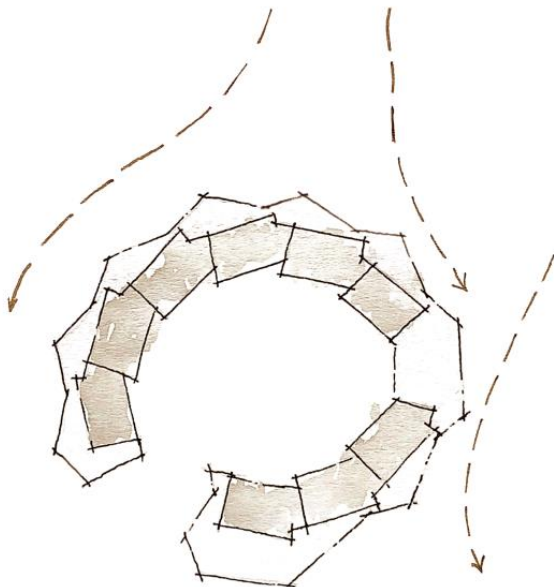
Disposición de las piezas como protección frente al viento. Esquema en planta del Liceo Schorge en Koudougou. Elaboración propia.
